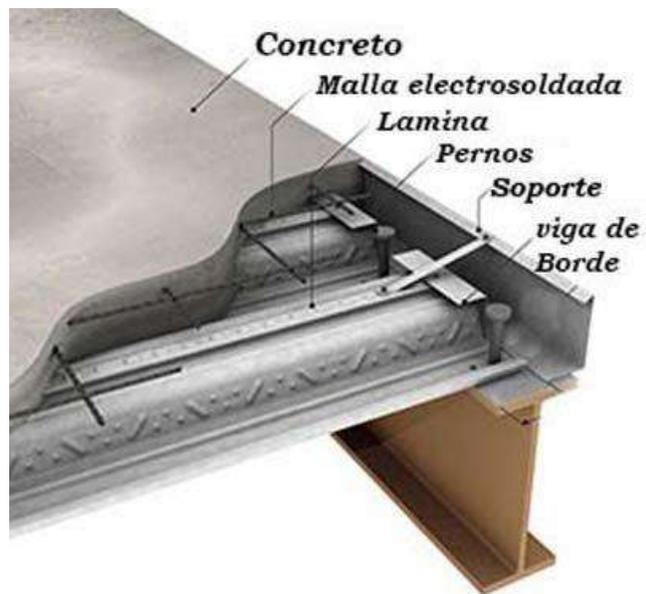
Componentes de una losa en construcción compuesta. Google imágenes.
